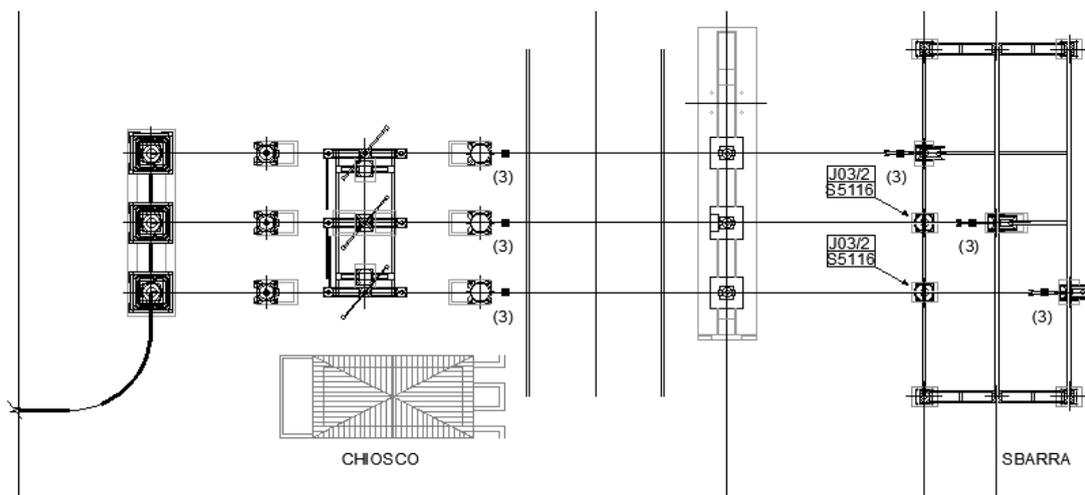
Planimetria elettromeccanica tipologica stallo di consegna Terna
